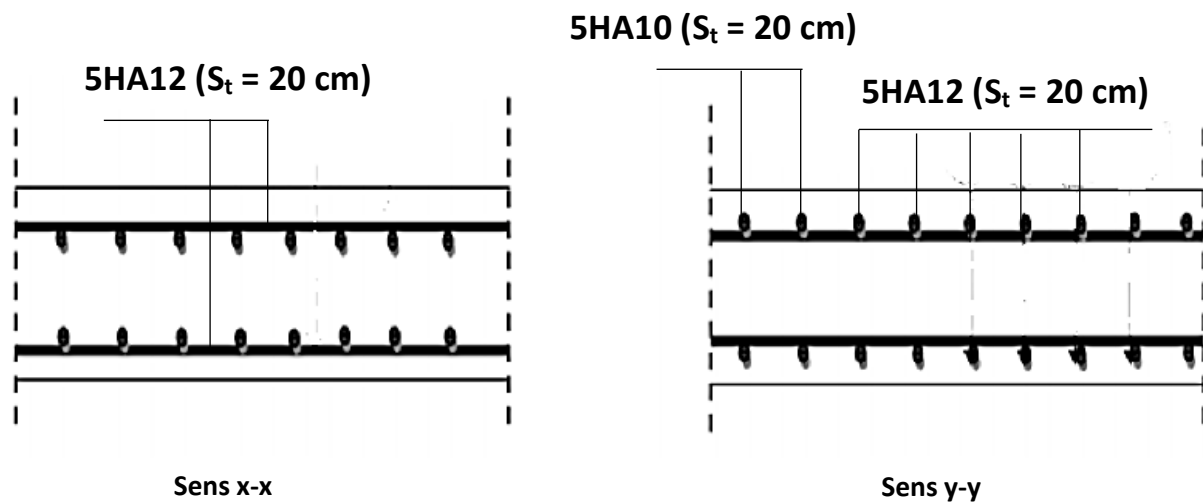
Ferrailage de la dalle pleine de la salle machine.
